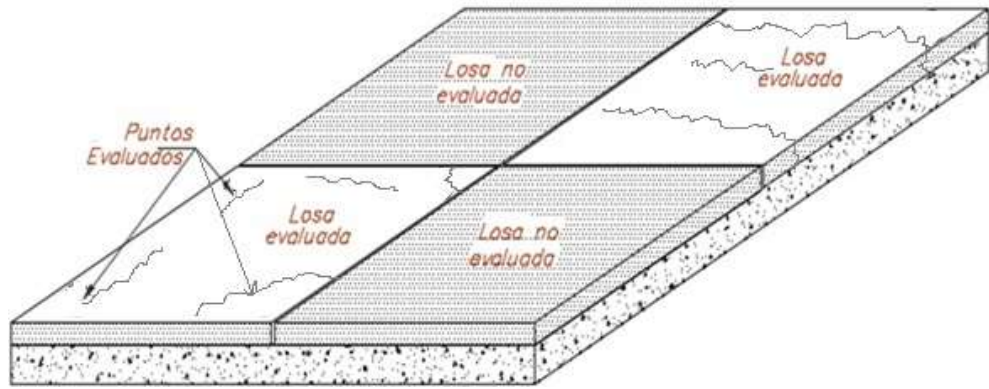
Puntos evaluados por fallas de fisuramiento en la losa de concreto.
